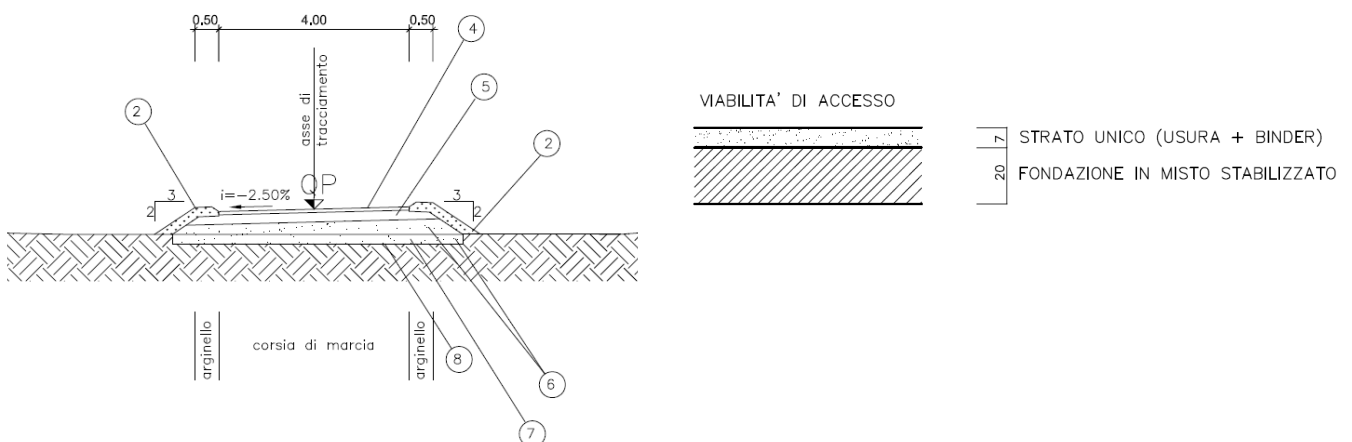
Sezione tipo e dettaglio della sovrastruttura stradale
